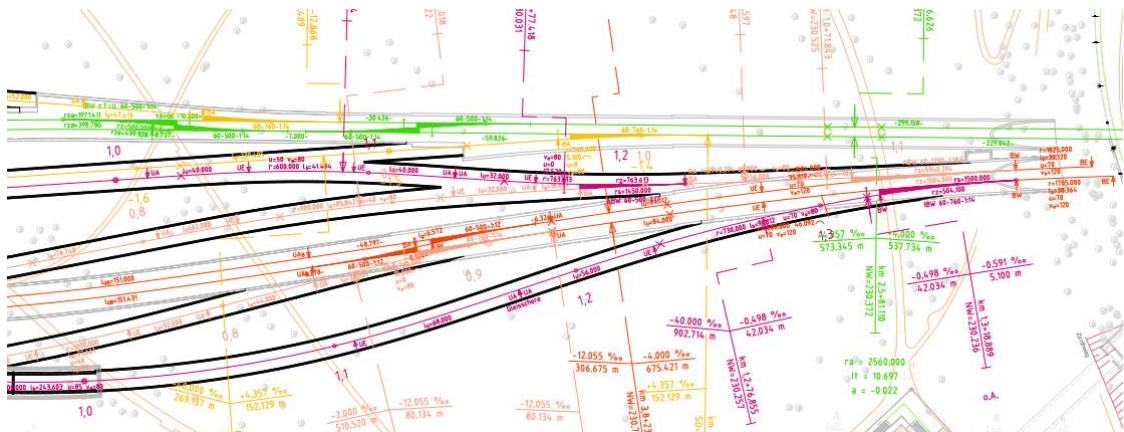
Variante 2a – Anschluss an Fernbahntunnel Bad Cannstatt zusammen mit Ergänzungsstation
